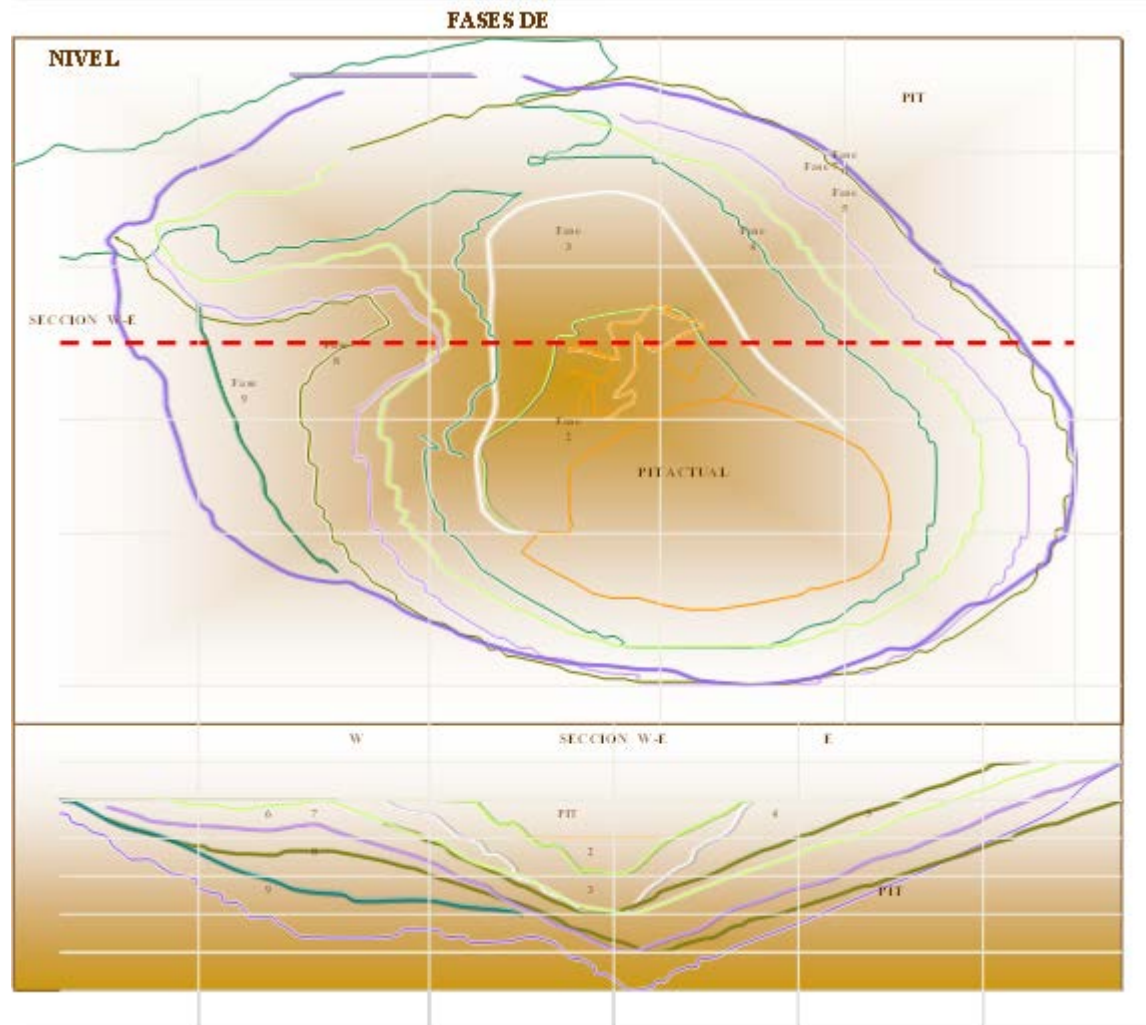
Vista de Planta y Transversal de las Fases de Minado en Mina Cuajone [11]
